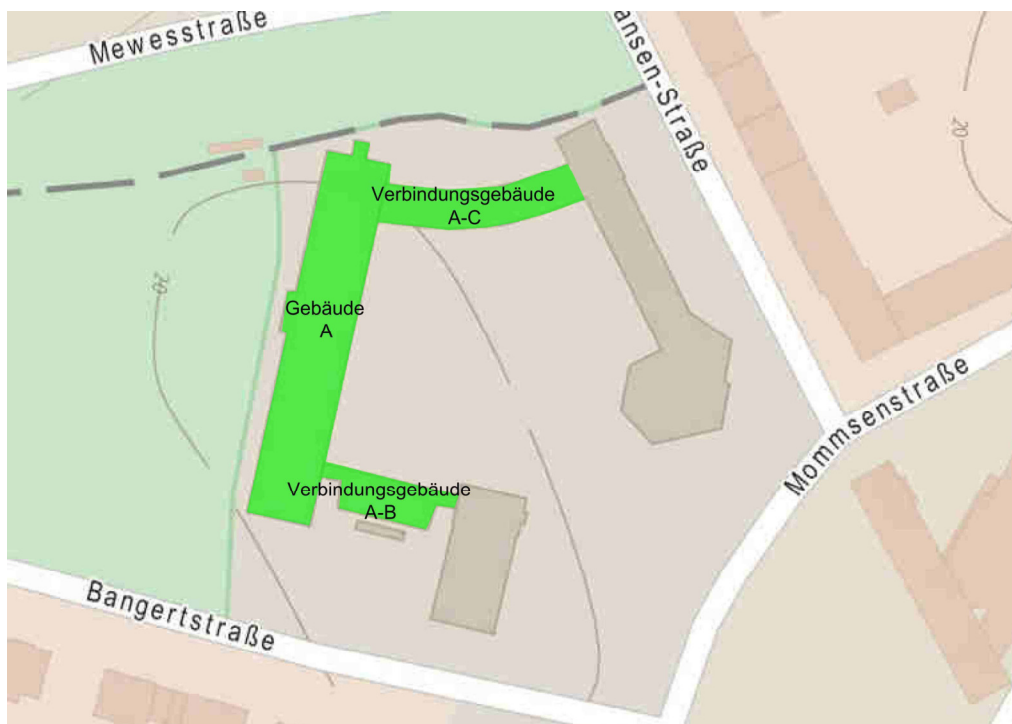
Lageplan mit den grün markierten und zu bewertenden Gebäuden
